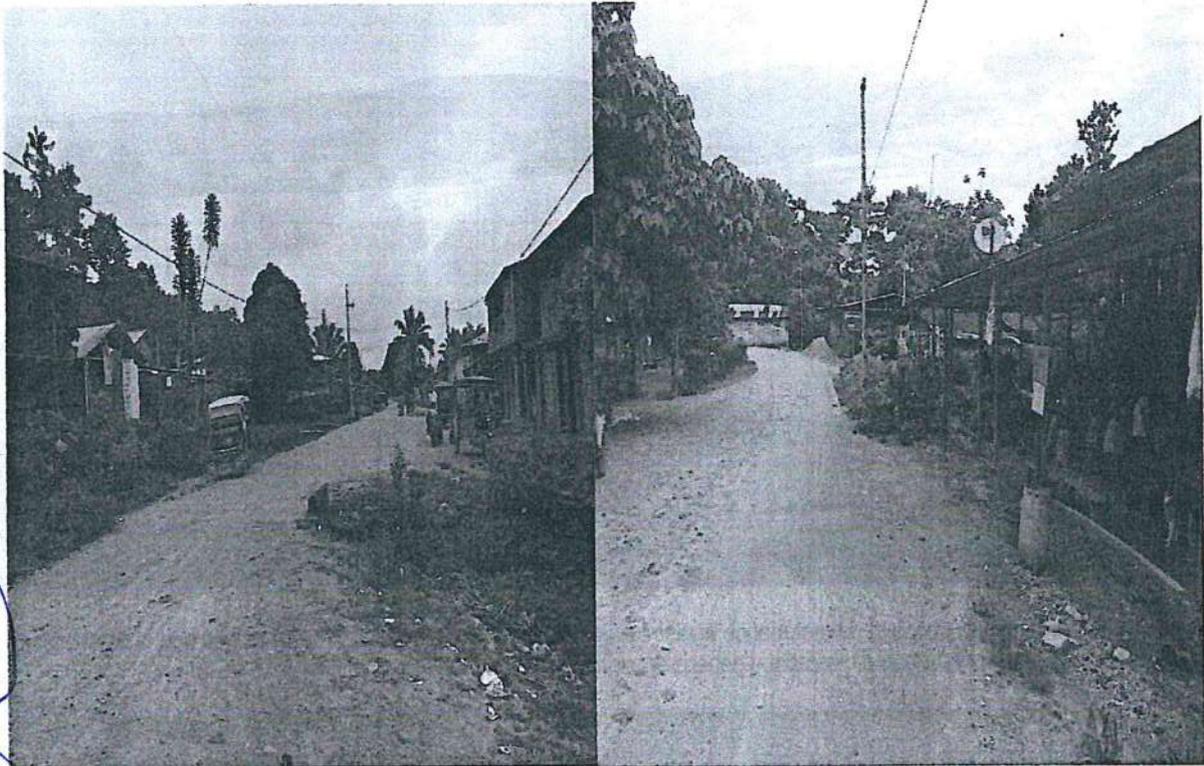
Viviendas principalmente construidas de material noble y de madera sin una adecuada técnica constructiva
